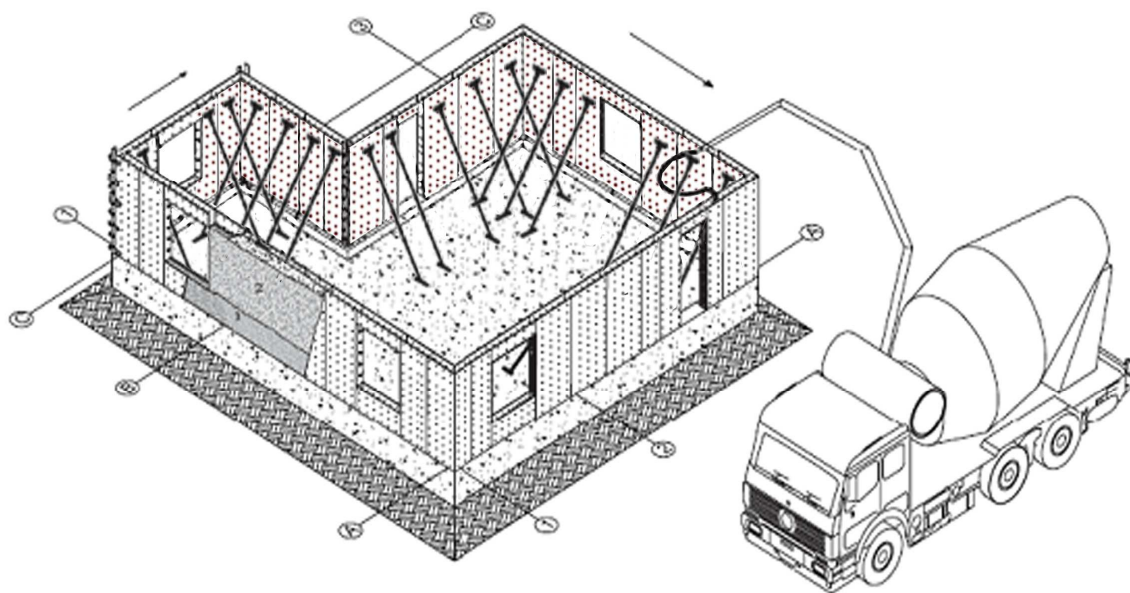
Бетонирование стены бетонным насосом и последовательность заполнения бетонной смеси.
